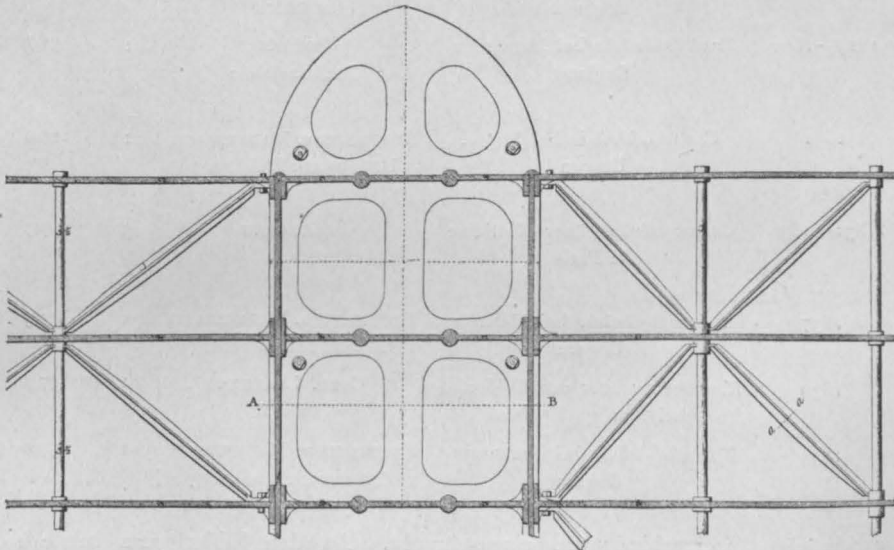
Grundriß der Chepstowbrücke über den Wye.
